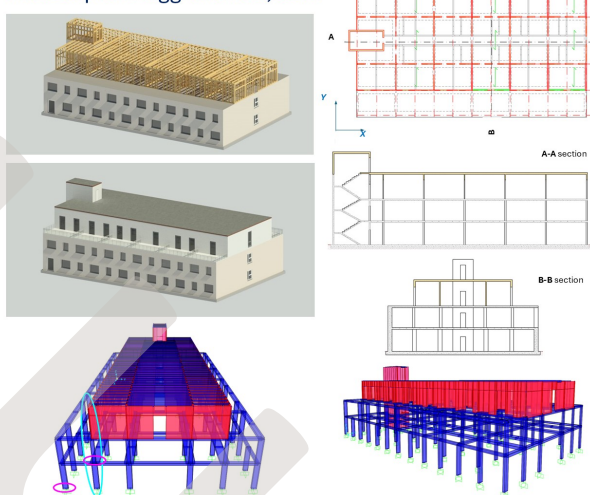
Pianta, sezioni, viste 3D e modello FEM della struttura con sopraelevazione LFT
